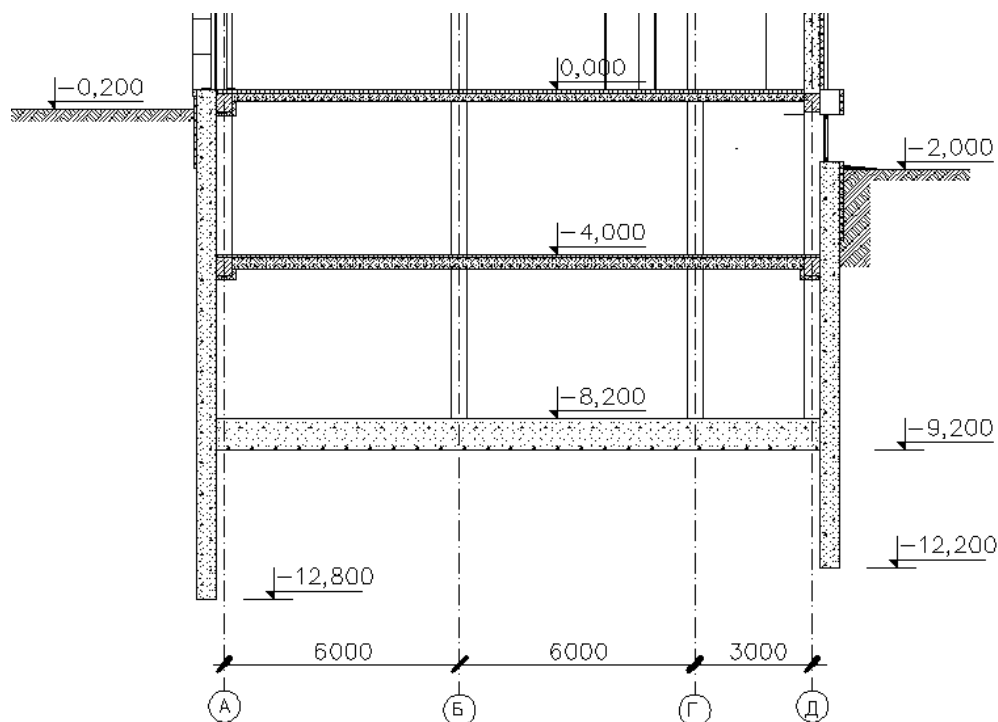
Разрез проектируемого здания с подземной двухэтажнойавтостоянкой и монолитная железобетонная стена в грунте
